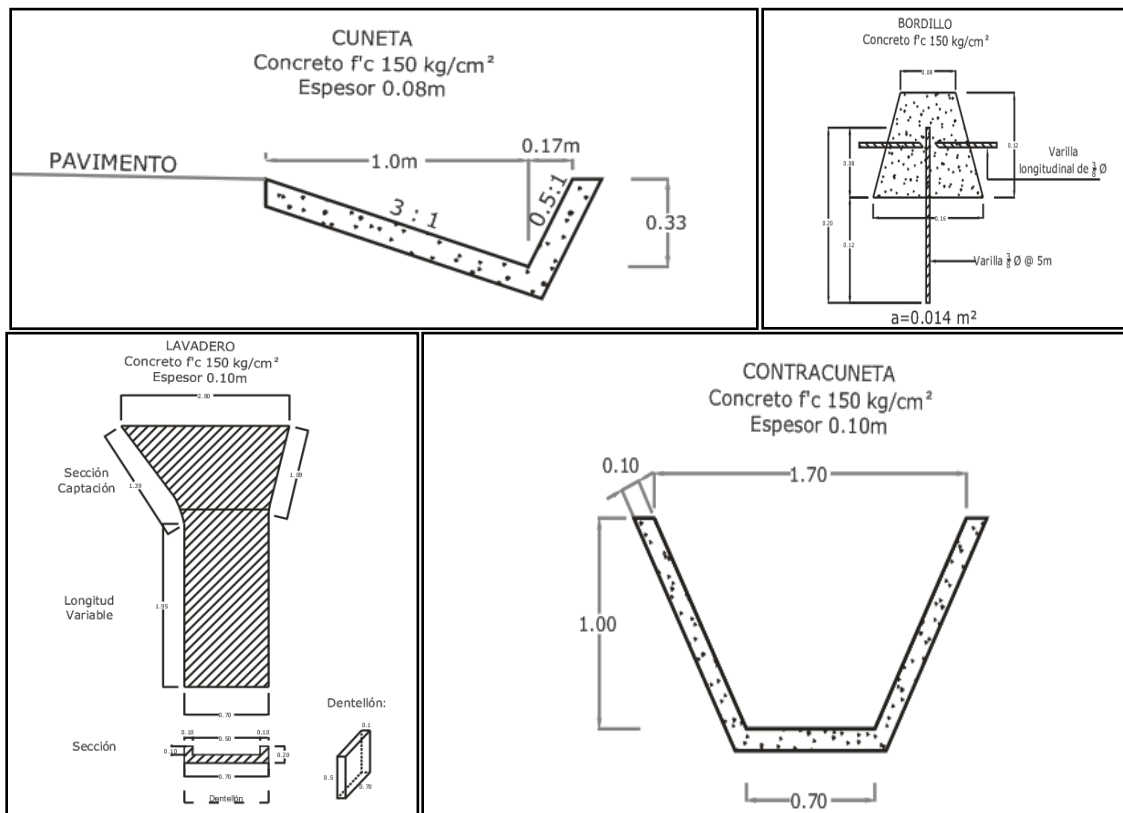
Sección tipo de las obras de drenaje complementarias de la construcción de la carretera tipo "C".
